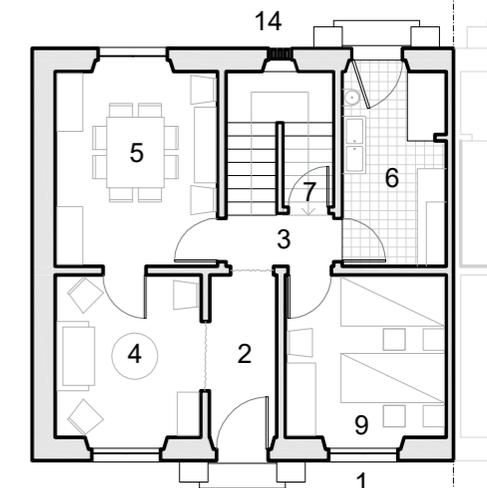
Planta de tipologia B3: Piso 0 (desenho do autor F.P. a partir da planta Anexo C)
